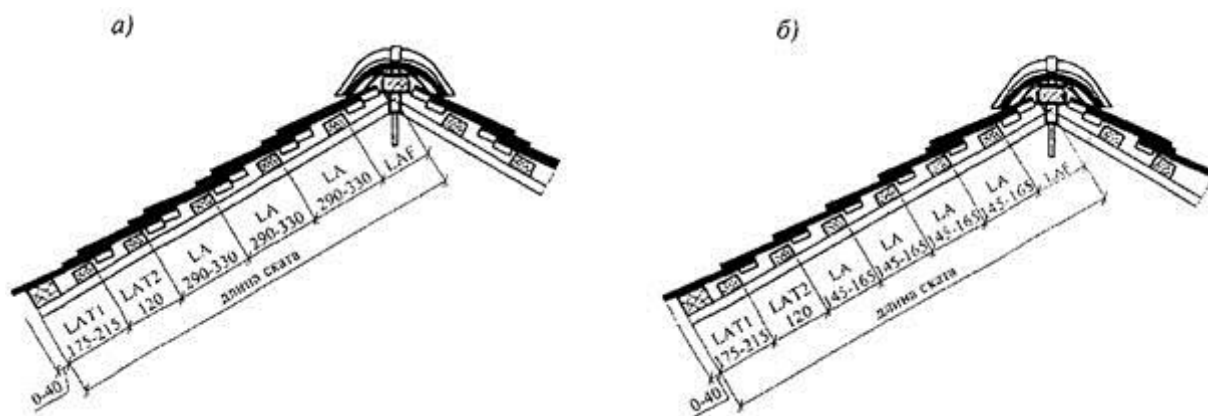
Поперечный разрез кровли (скат кровли) при двойной (а) и при корончатой (б) укладке черепицы
